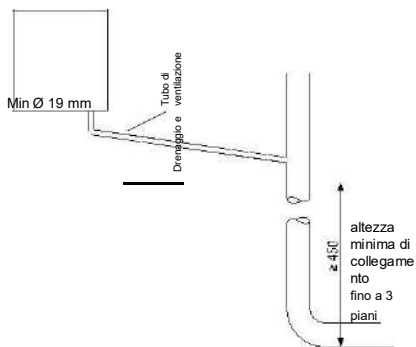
Collegamento del tubo di drenaggio dell'acqua di condensa al tubo di drenaggio e ventilazione interna
